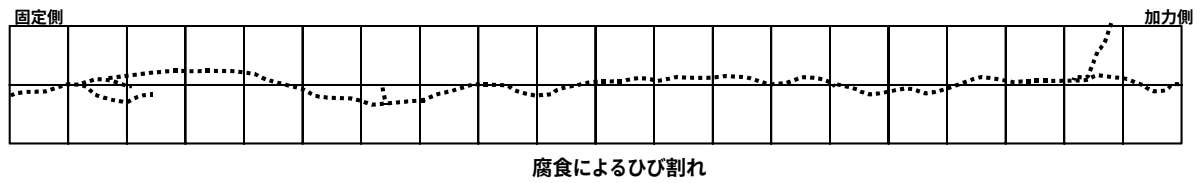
ひび割れ開口に対する拘束筋を有する試験体のひび割れ発生状況
